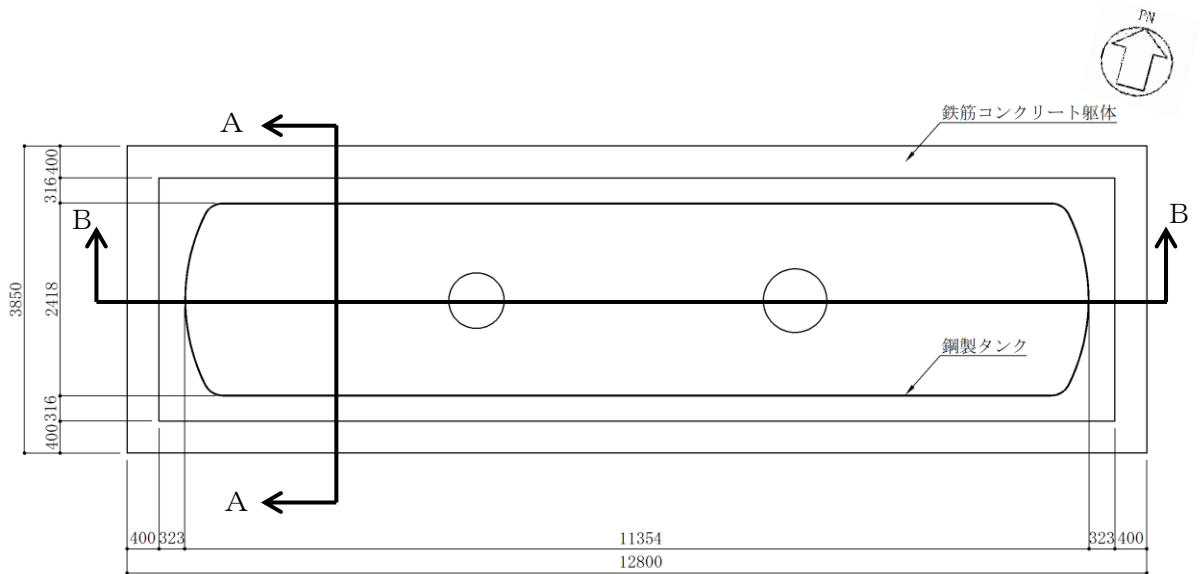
緊急時対策所用燃料地下タンク 平面図
